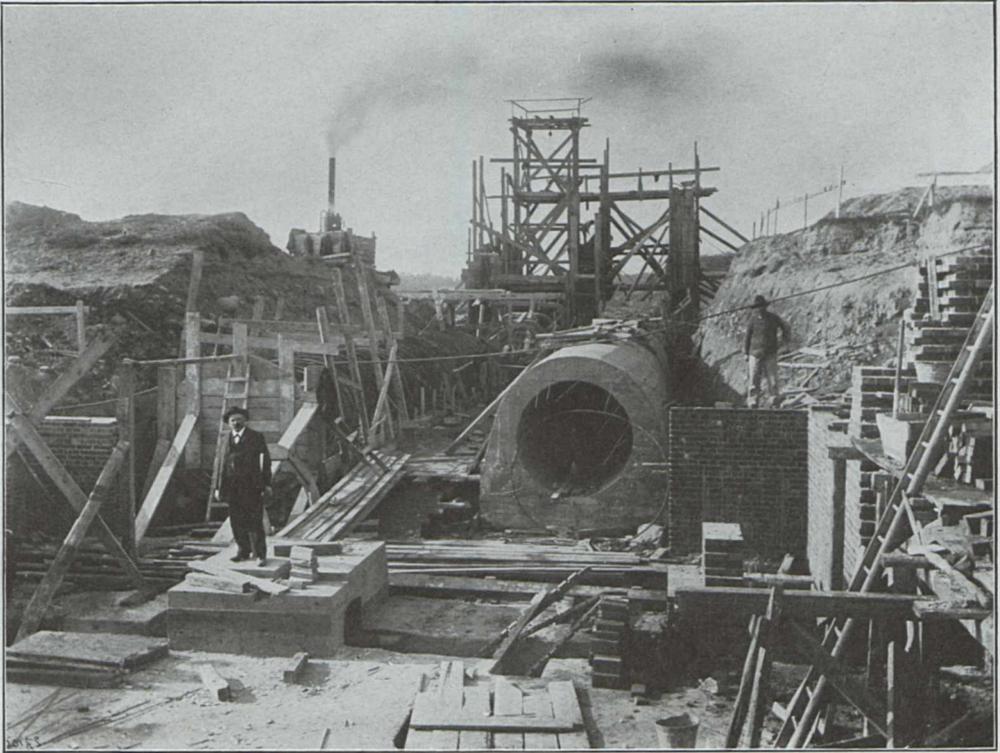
Druckrohr der Turbinenanlage in Eisenbeton, im Bau.
